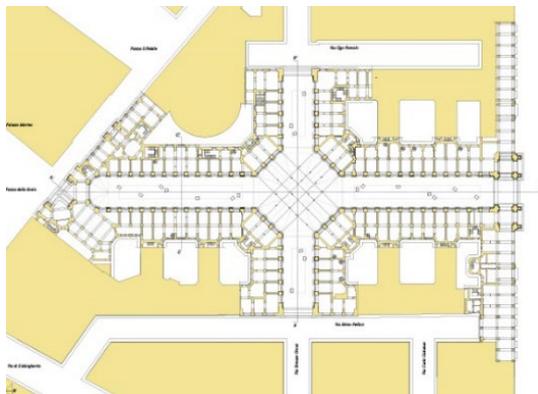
Planimetria della Galleria Vittorio Emanuele
